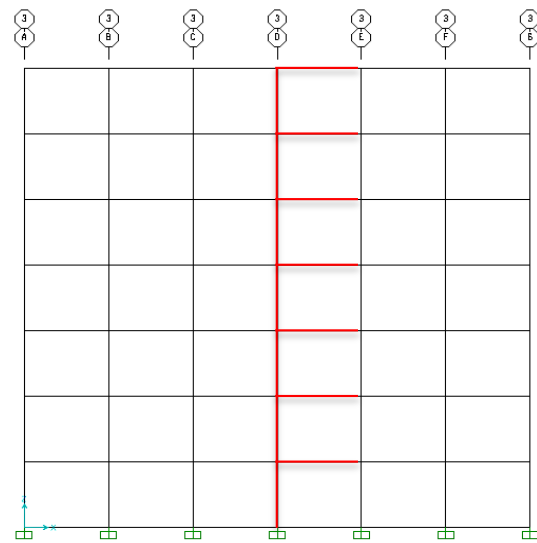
Kolom untuk lantai 1 sampai dengan lantai 4
